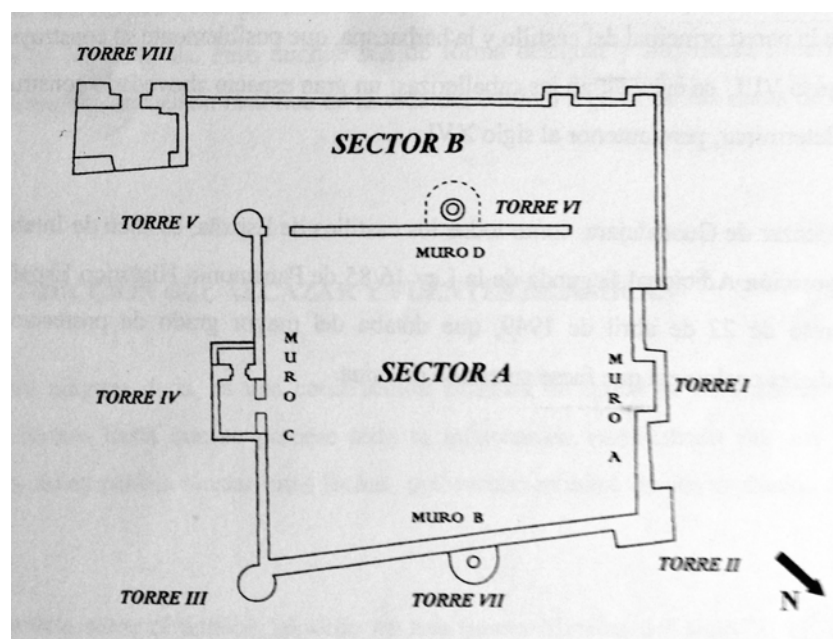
Planta del Alcázar. Cuadrado Prieto, M.A./Crespo Cano, M.L./Arenas Esteban, A
